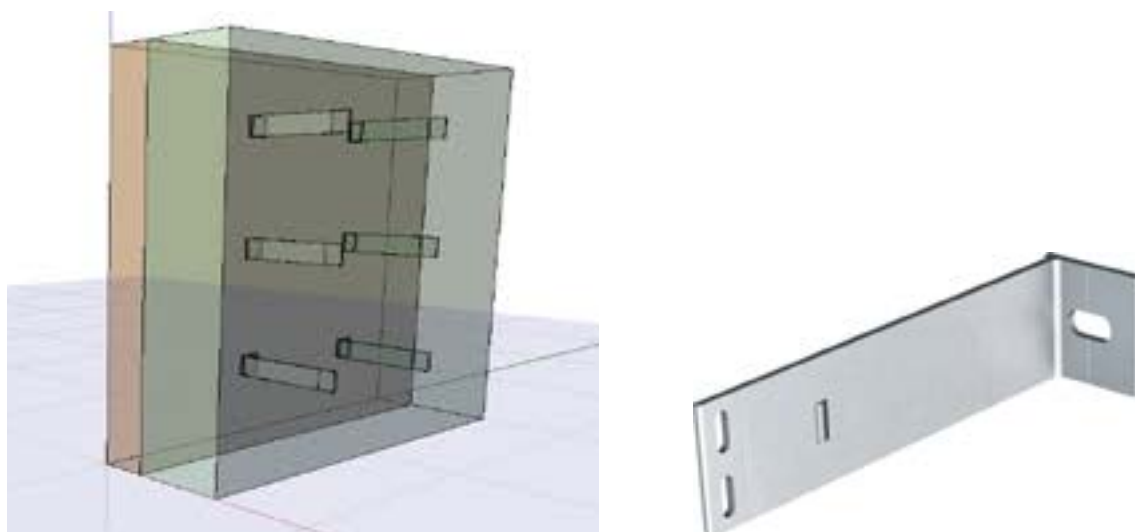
Zobrazenie roštu prevetrávanej fasády a typ mechanickej kotvy
